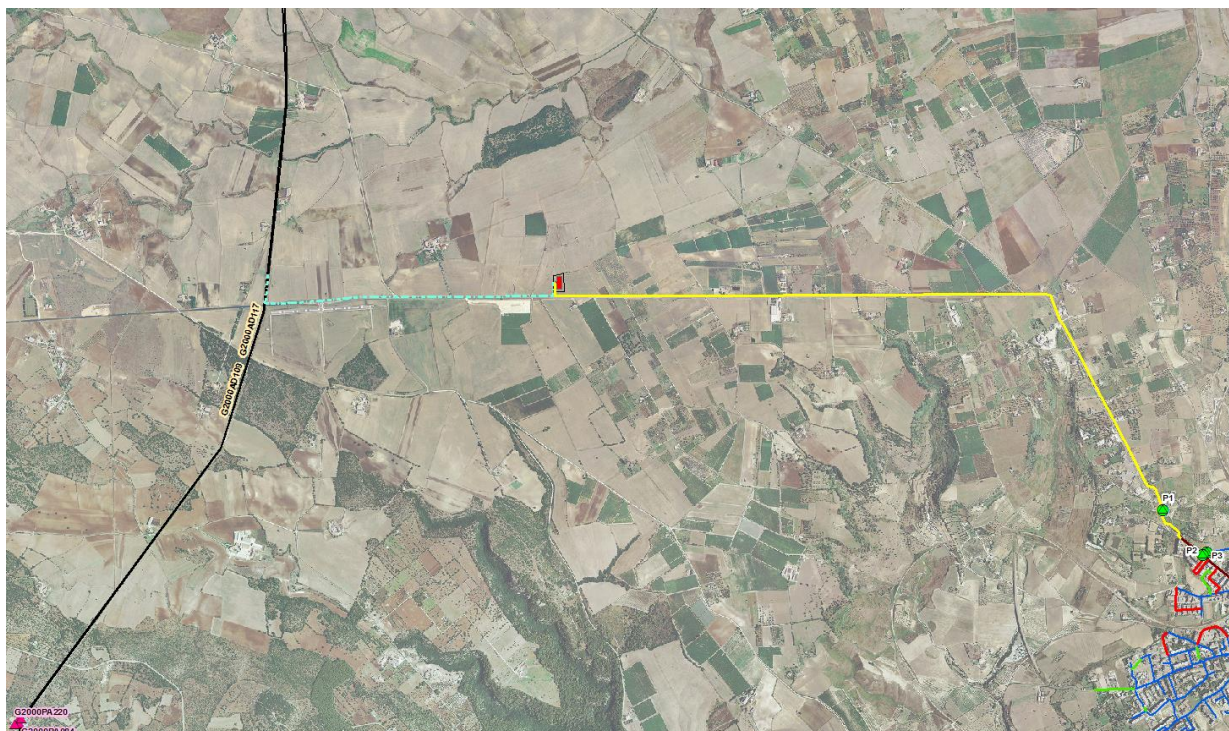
Interventi di progetto della rete idrica di adduzione: in giallo la suburbana.
